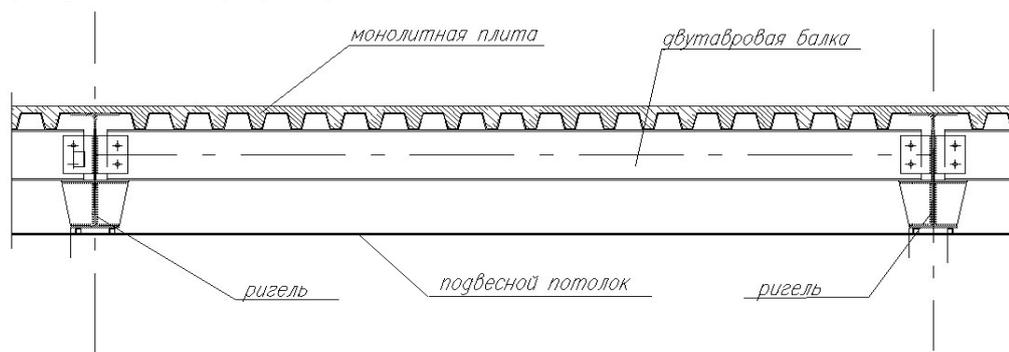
Конструкция облегченного междуэтажного перекрытия.
